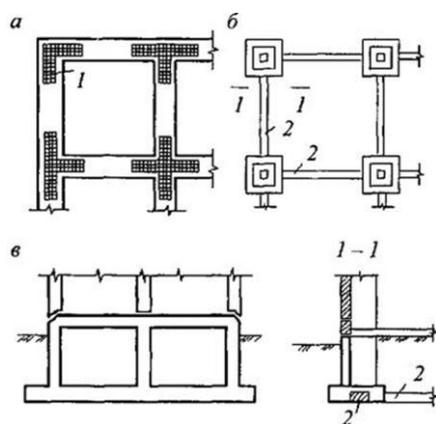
Конструкции фундаментов при сейсмических воздействиях: а - план ленточного фундамента; б - план и разрез отдельных (столбчатых) фундаментов; в - подвальная часть здания с плитным фундаментом из монолитного железобетона; 1 - арматурные сетки; 2 - железобетонные балки-связи
